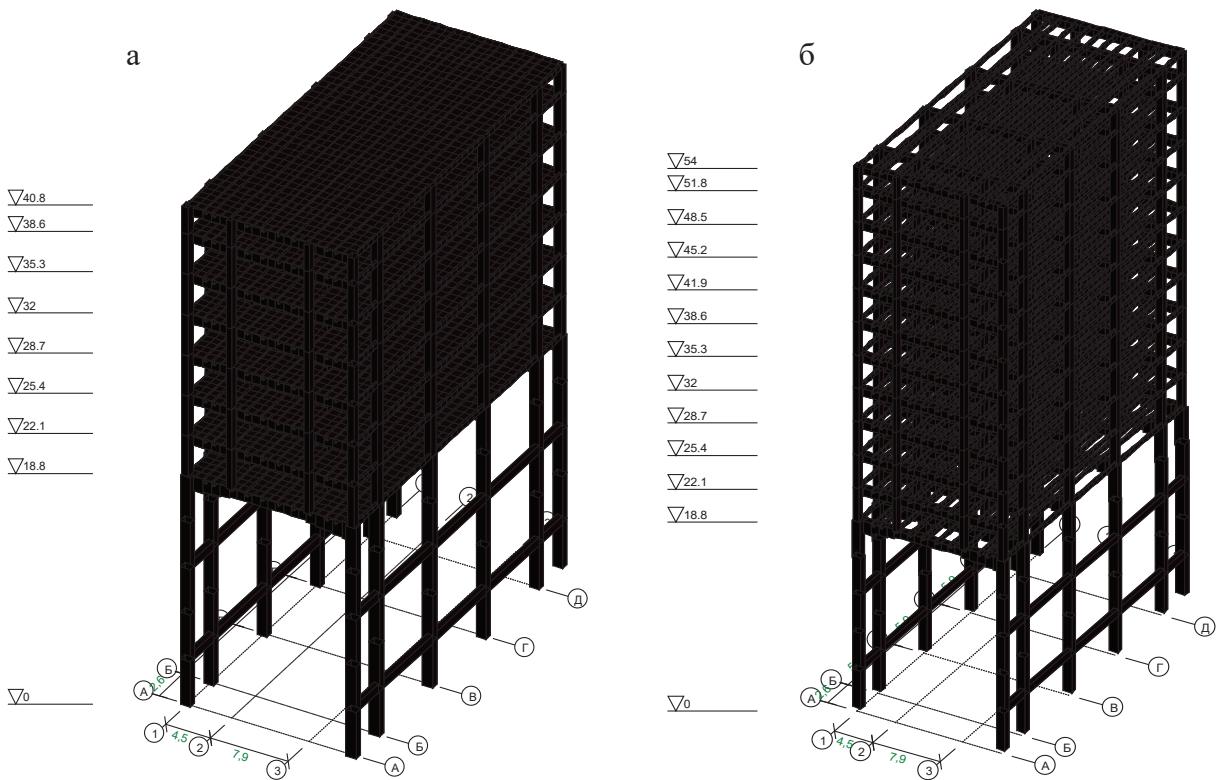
Схема 7-ми этажной (а) и 11-ти этажной (б) надстройки из монолитного железобетона
